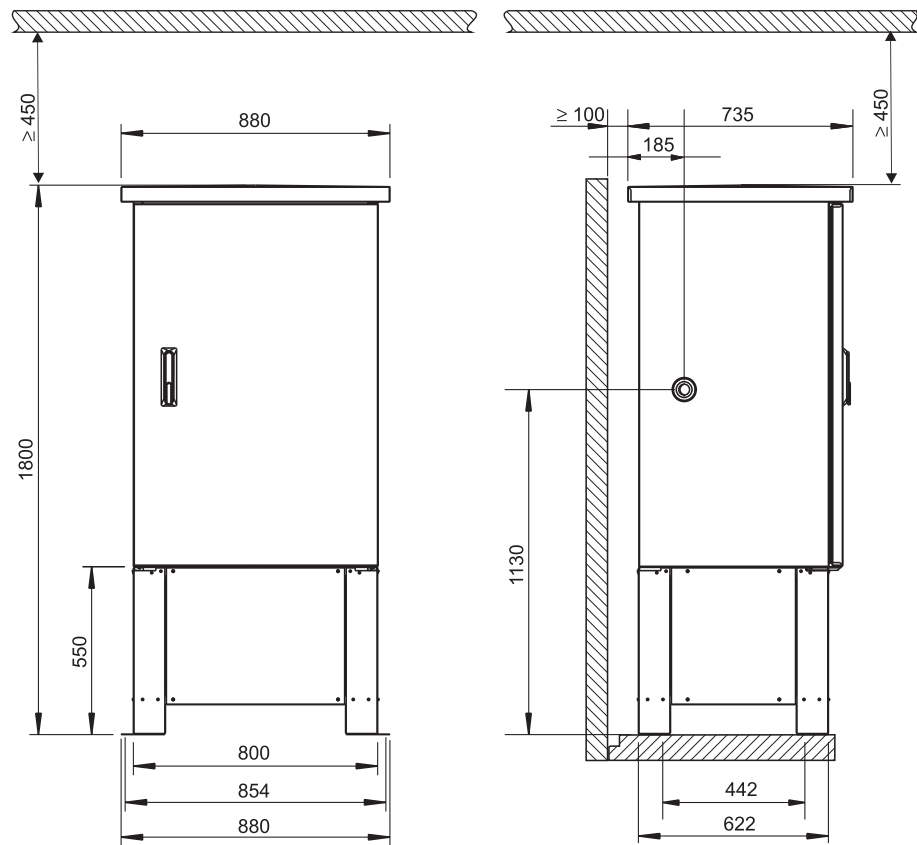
Cabina standard con basamento (dimensioni in mm)
